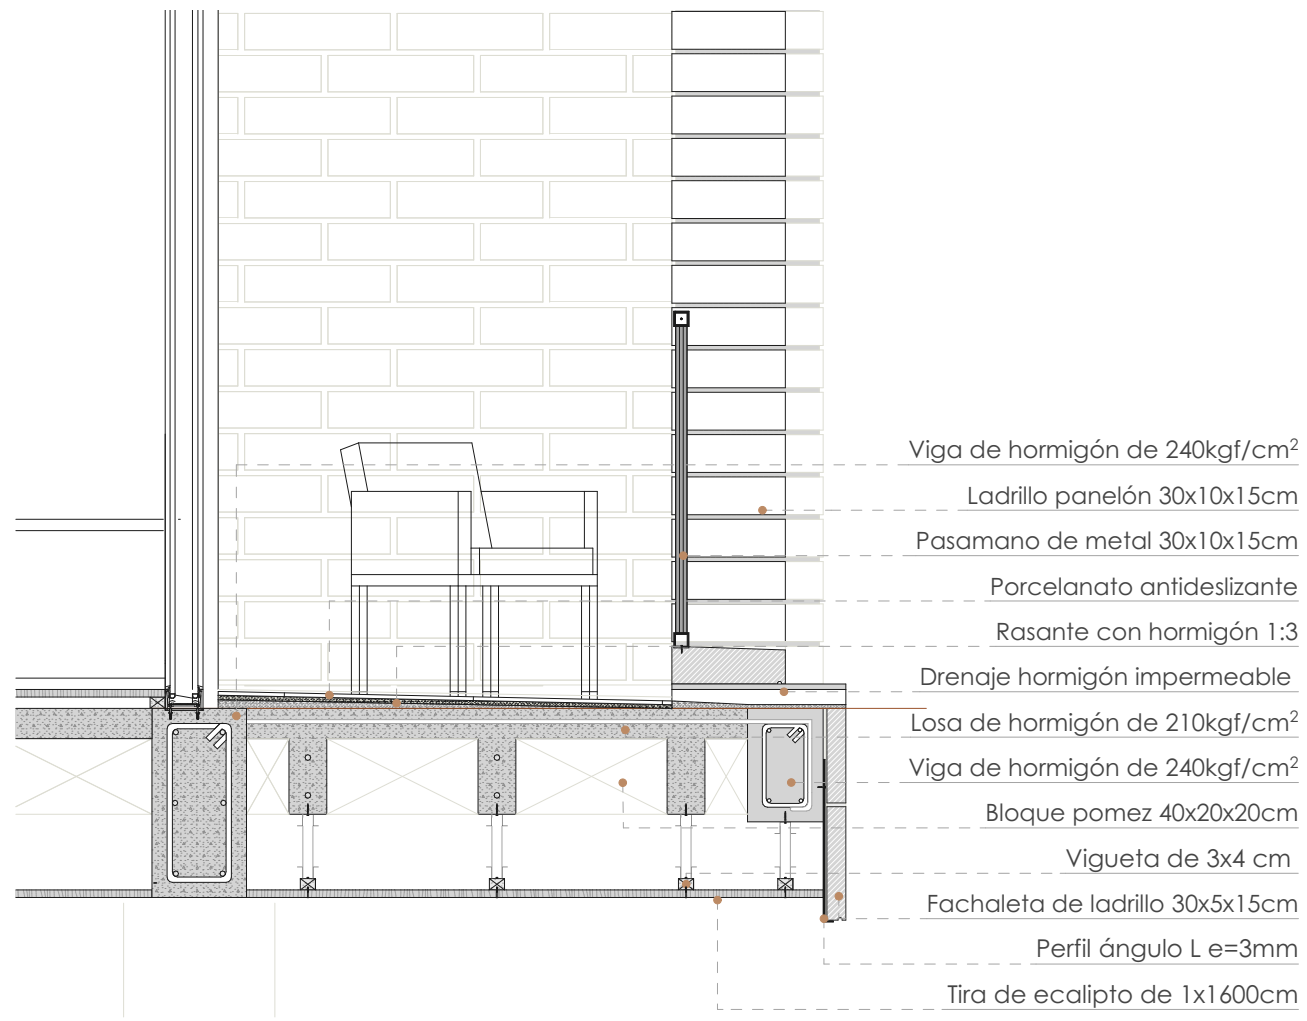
Cierre de Fachada. Fuente: Autoría propia.
